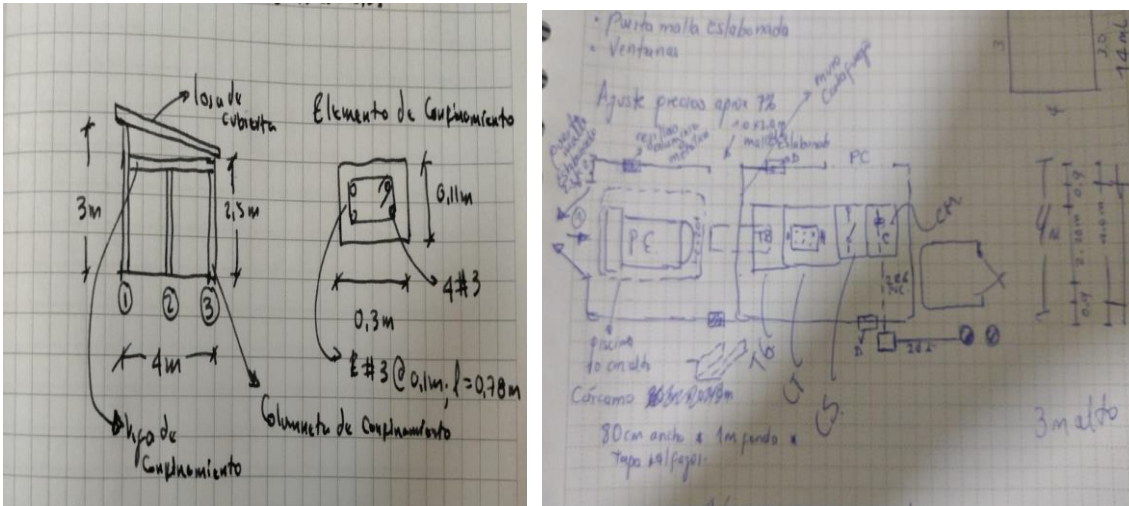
planta de losa de cubierta y cálculo de cantidades
